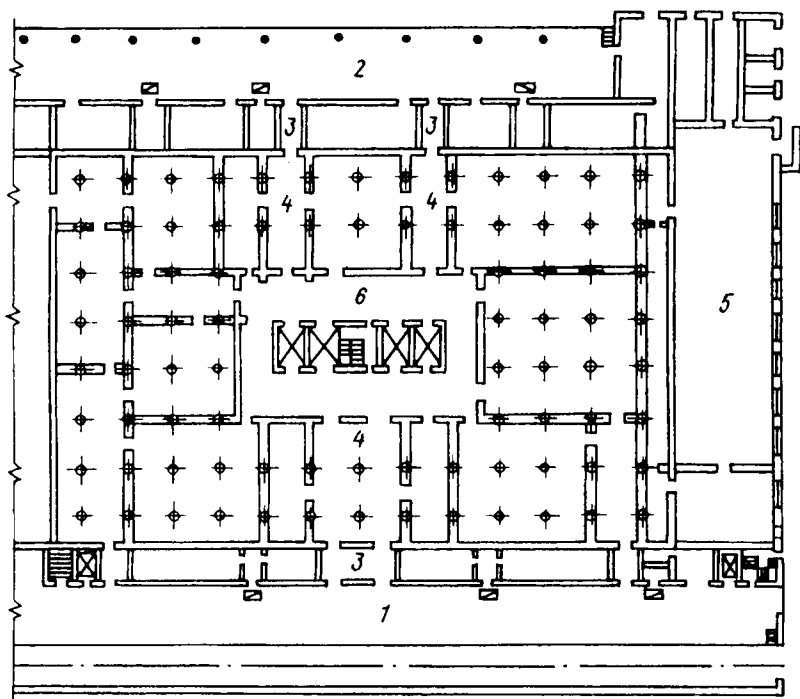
Планировка первого этажа Московского холодильника № 12:
